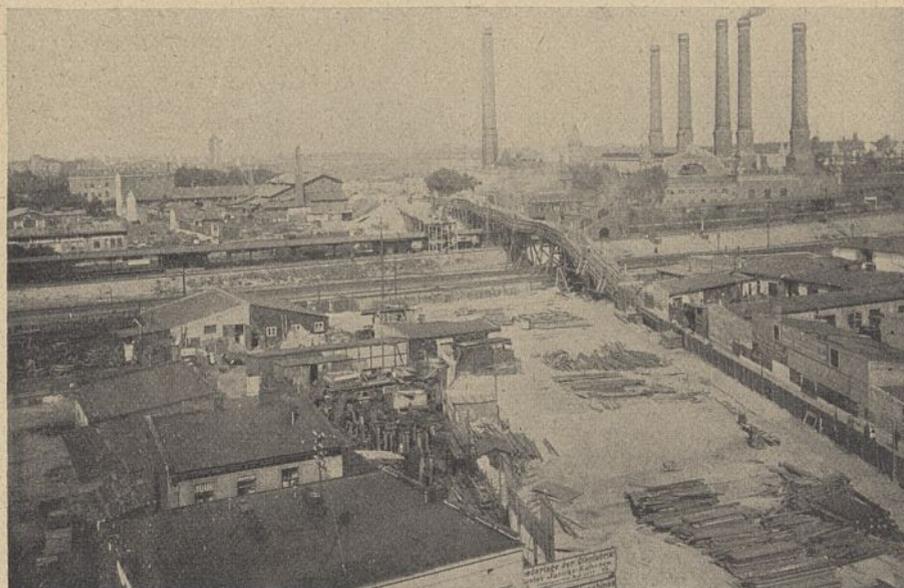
Putlitzbrücke, Baustelle vom Dach des Hauses Putlitz-Quitowstraße aus gesehen.
